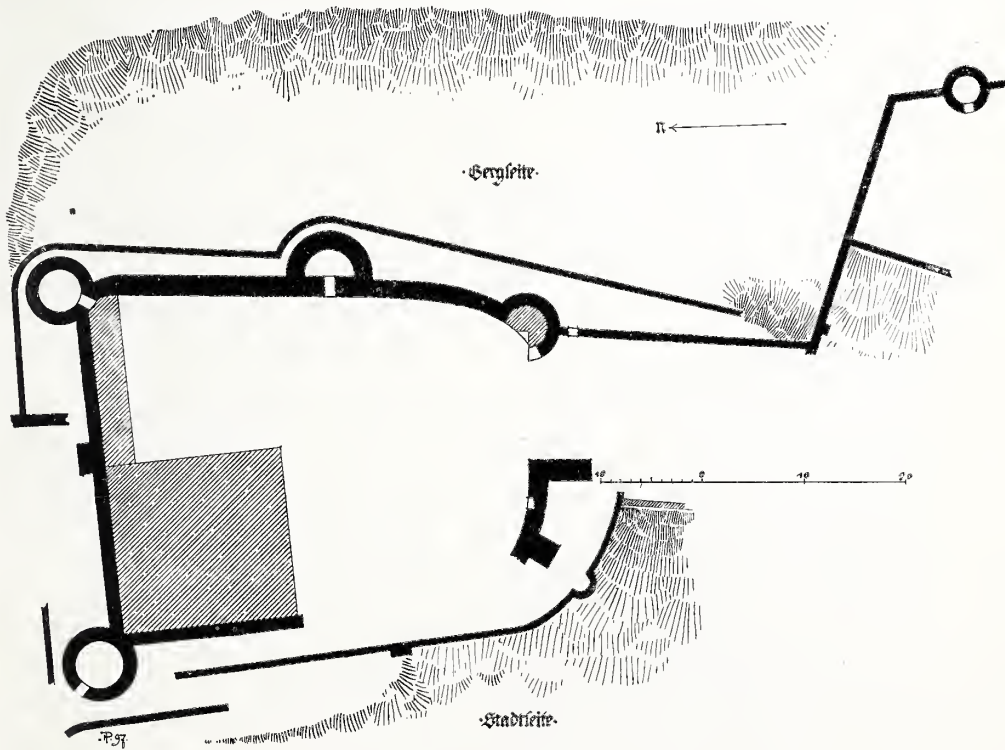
Münsteriefel. Grundriss der Schlossruine.
